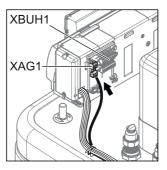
Elektrische Anschlüsse Gehäuserückseite (siehe Kap. 4.5.1) herstellen
